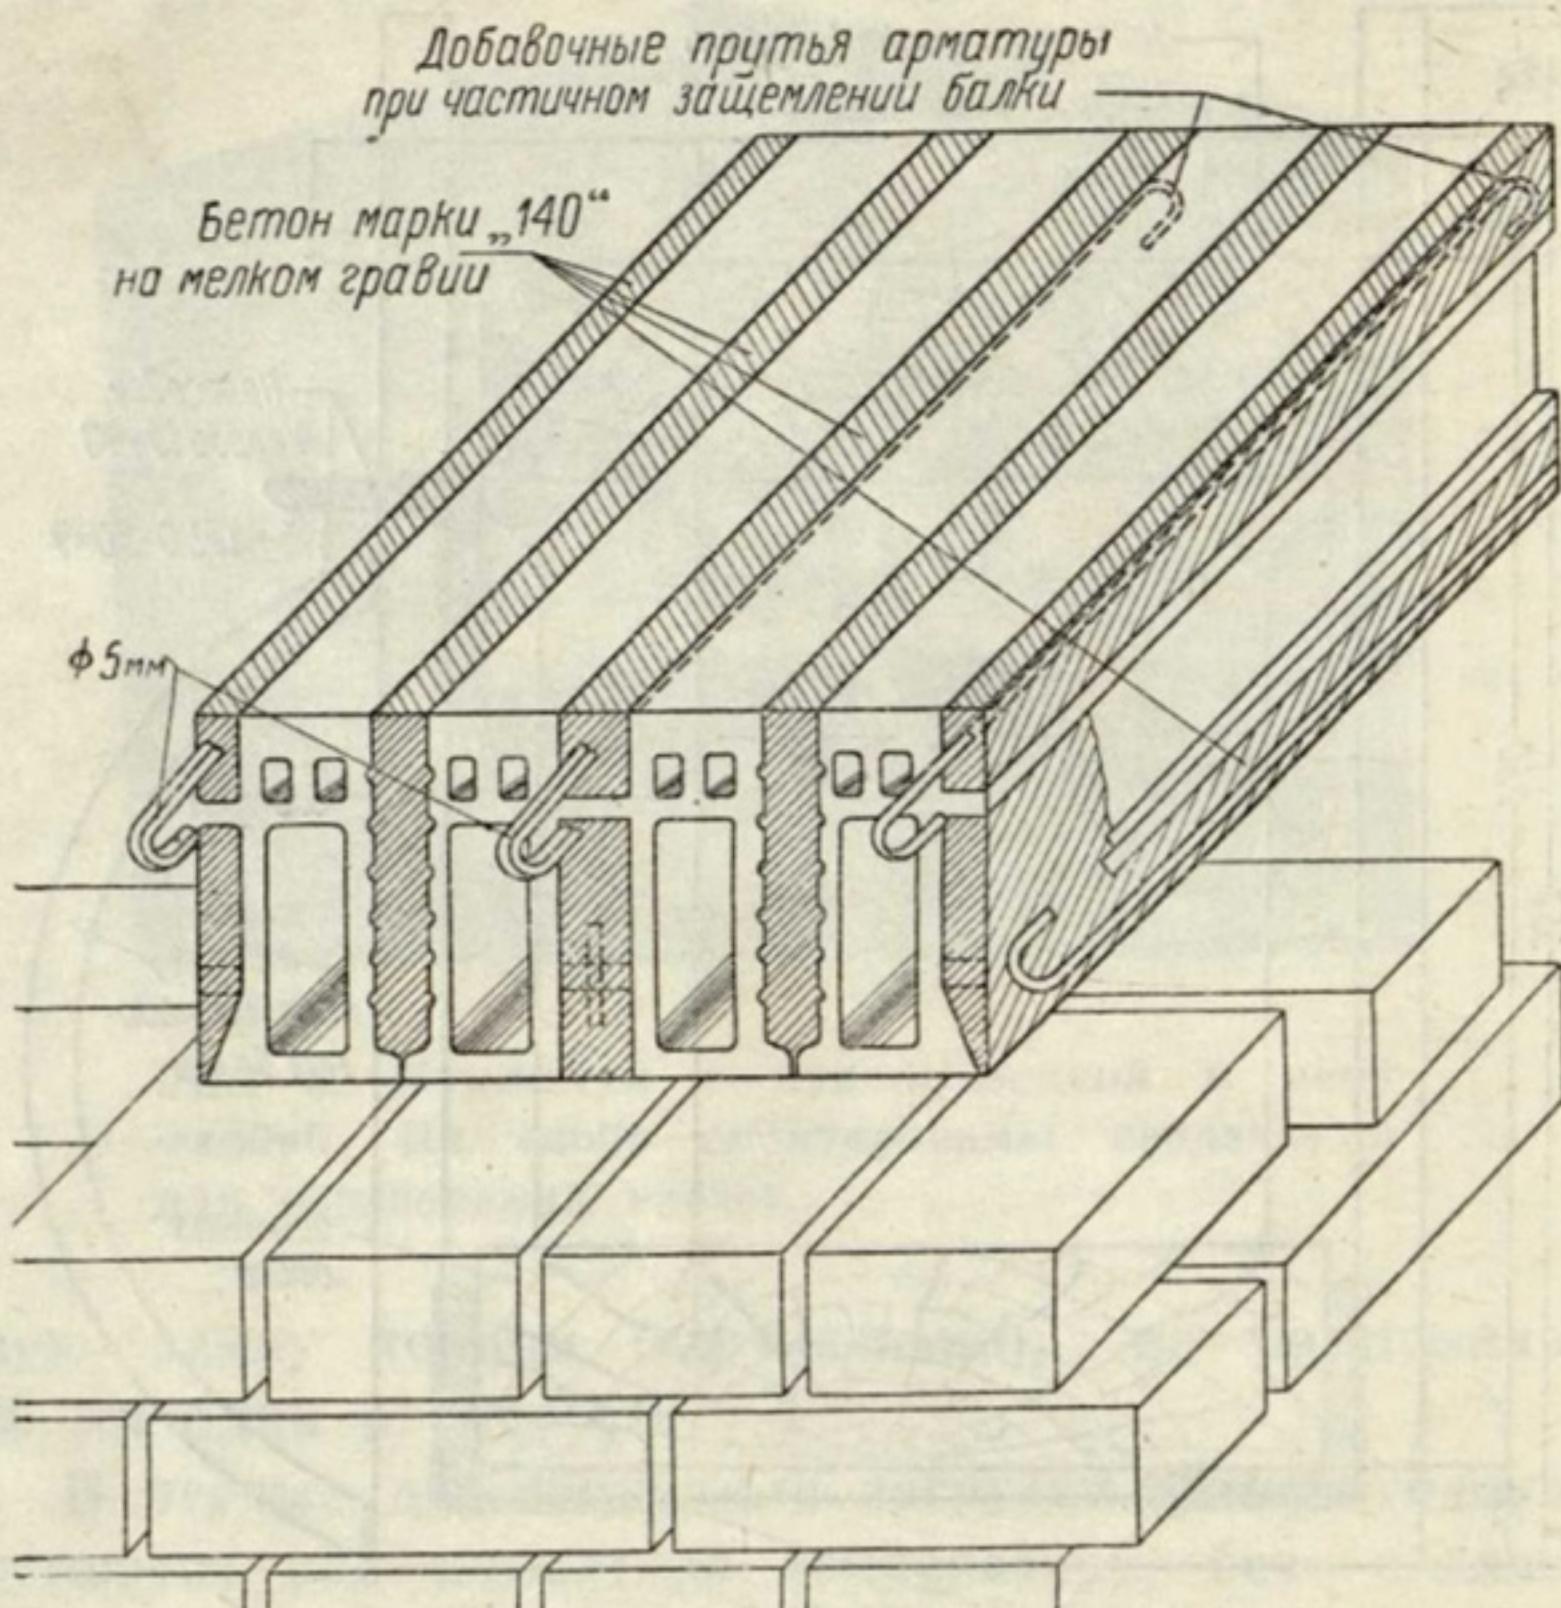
Деталь перекрытия из керамических блоков «Стандарт».
